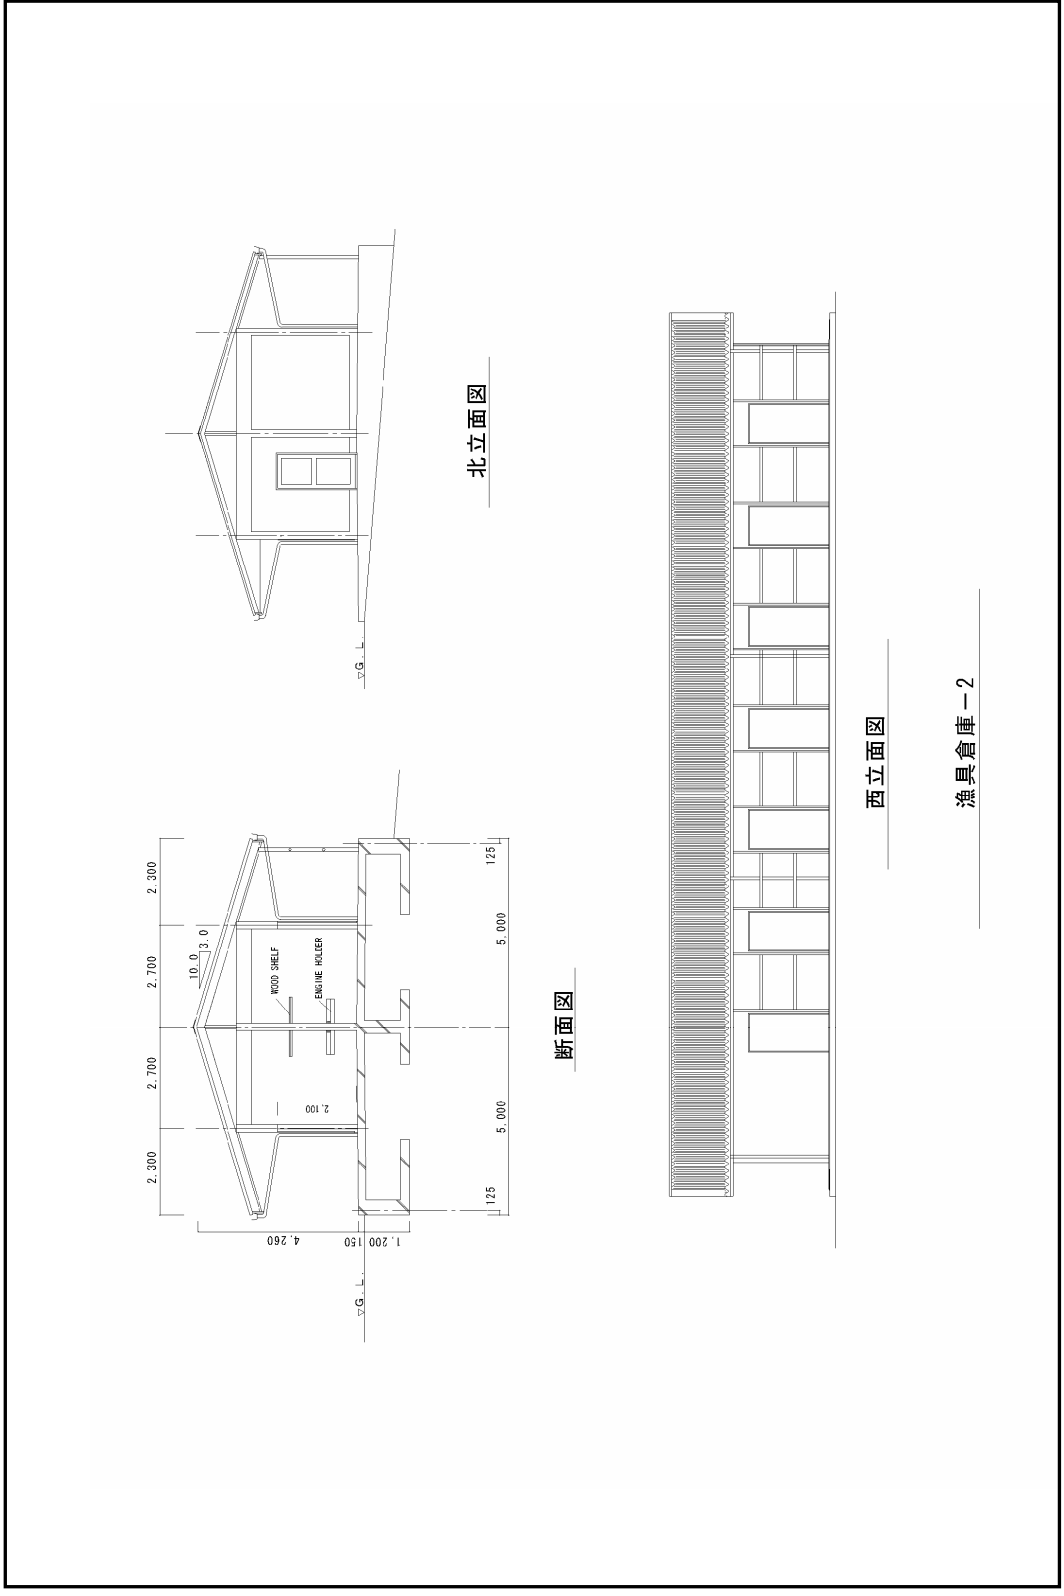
(14) 渔具倉庫 2 立面 · 断面图
